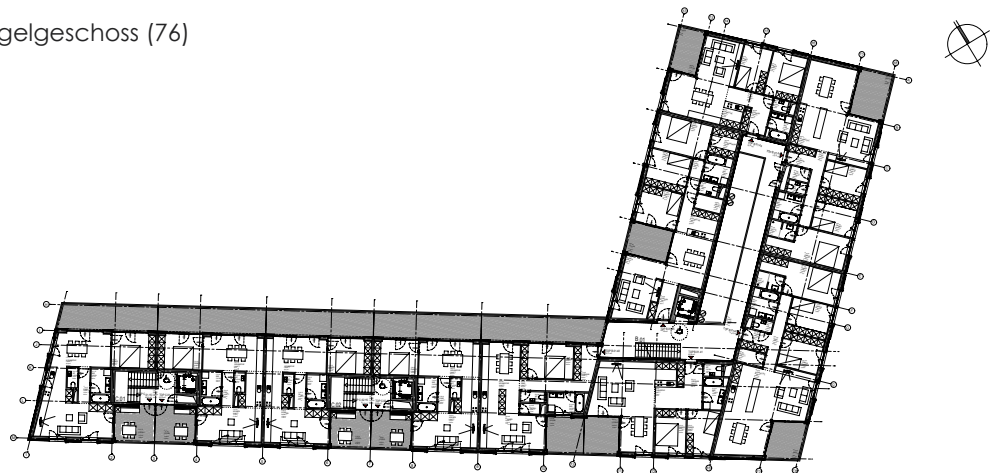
Grundriss Dachgeschoss (76)
